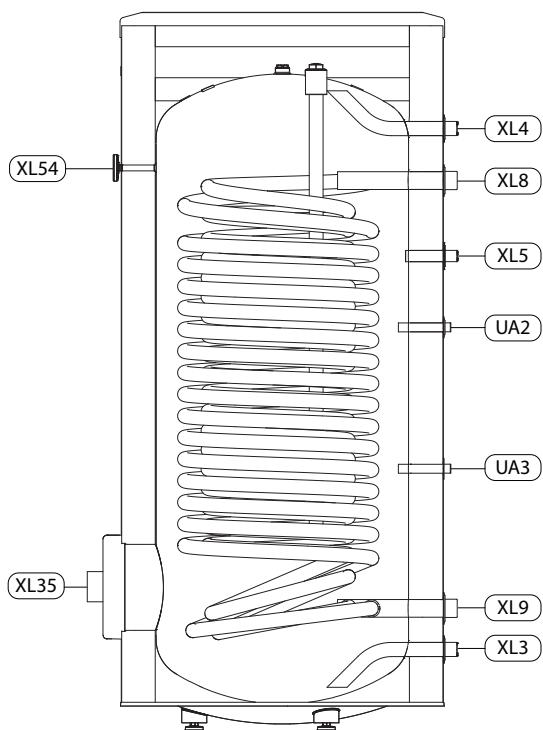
Dimensioner på BA-ST 9040/9050 -1FEDC tilslutningsstudser
